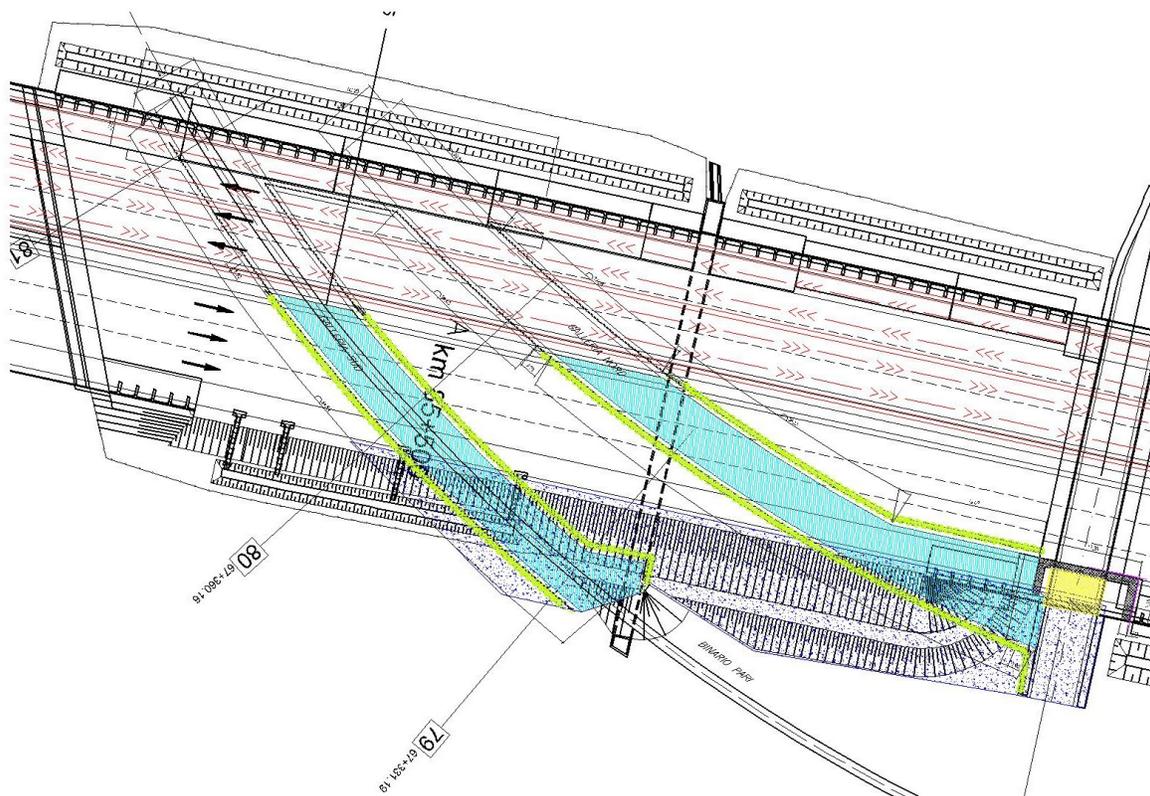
Pianta delle sequenze lavorative di fase 2A e 2B.
